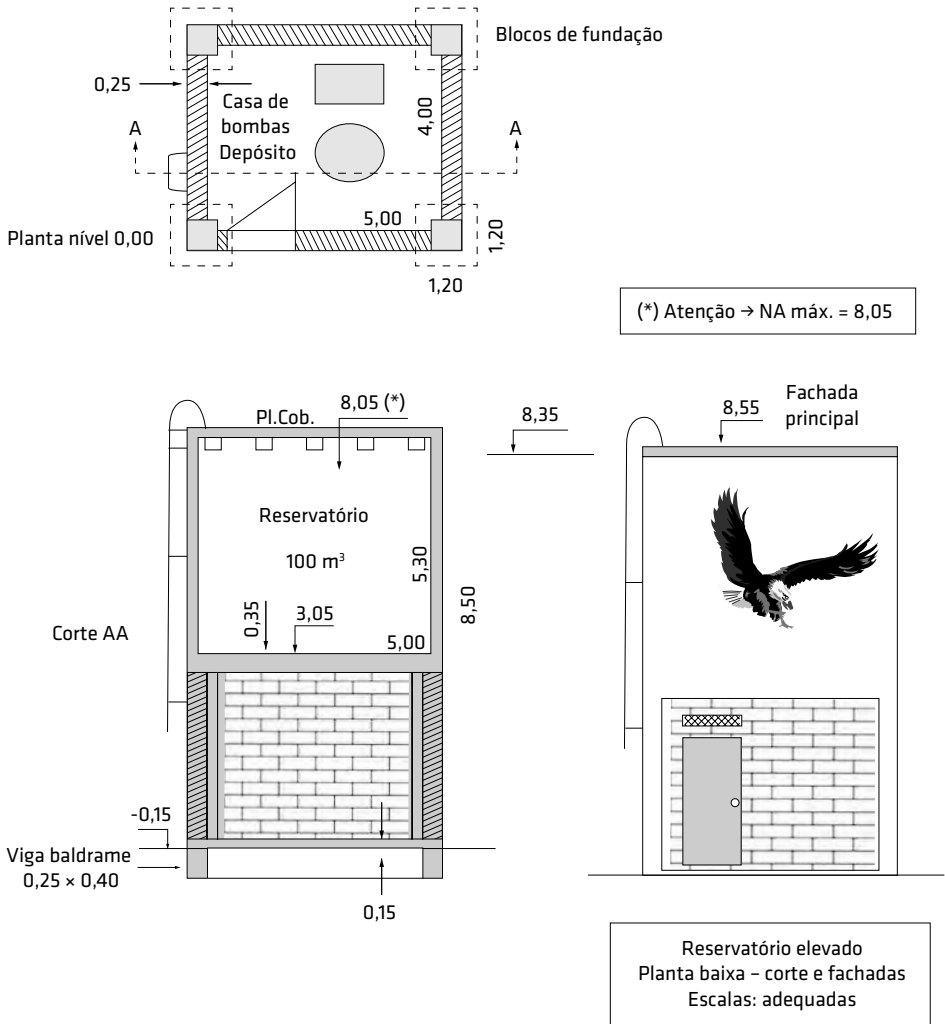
Planejamento com orçamento integrado – corte e fachadas
